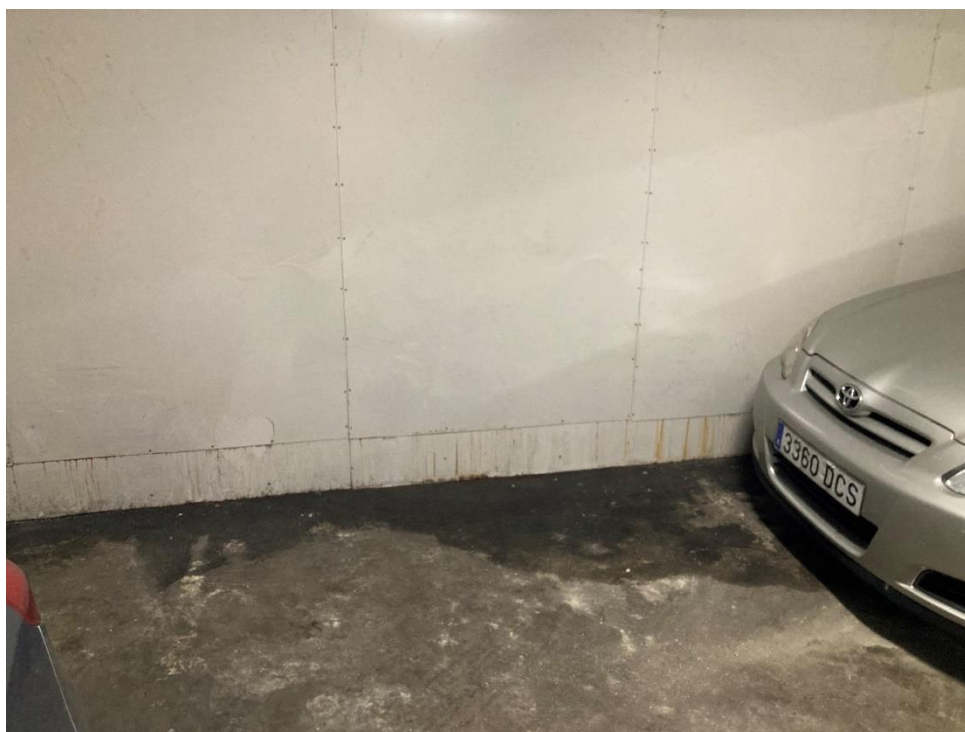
Humedades del muro perimetral zona- esquina inferior derecha, planta S-1
